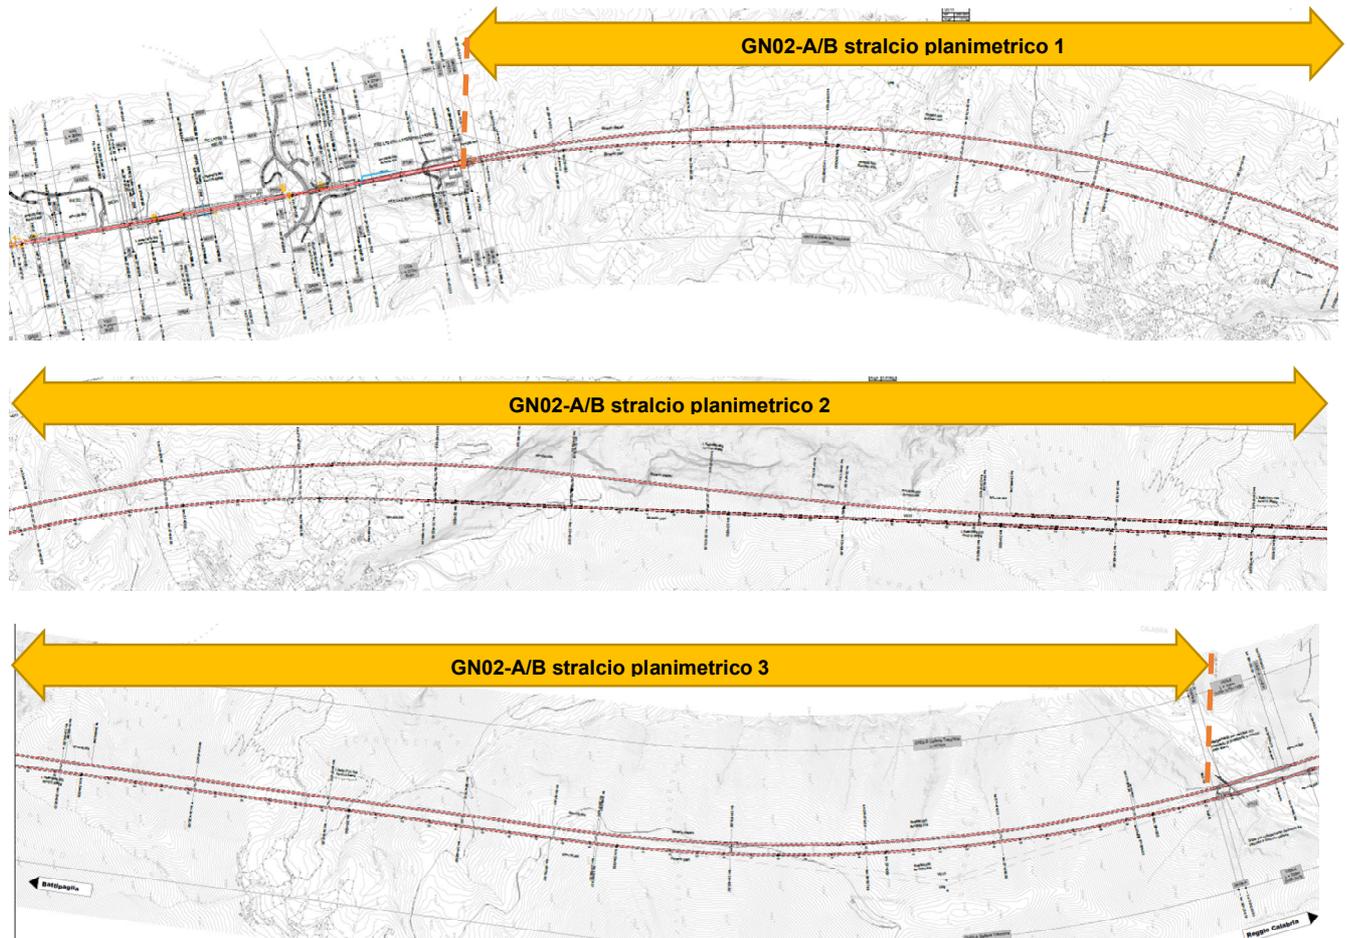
Planimetria di progetto da km 27+964 al km 28+646 BP
